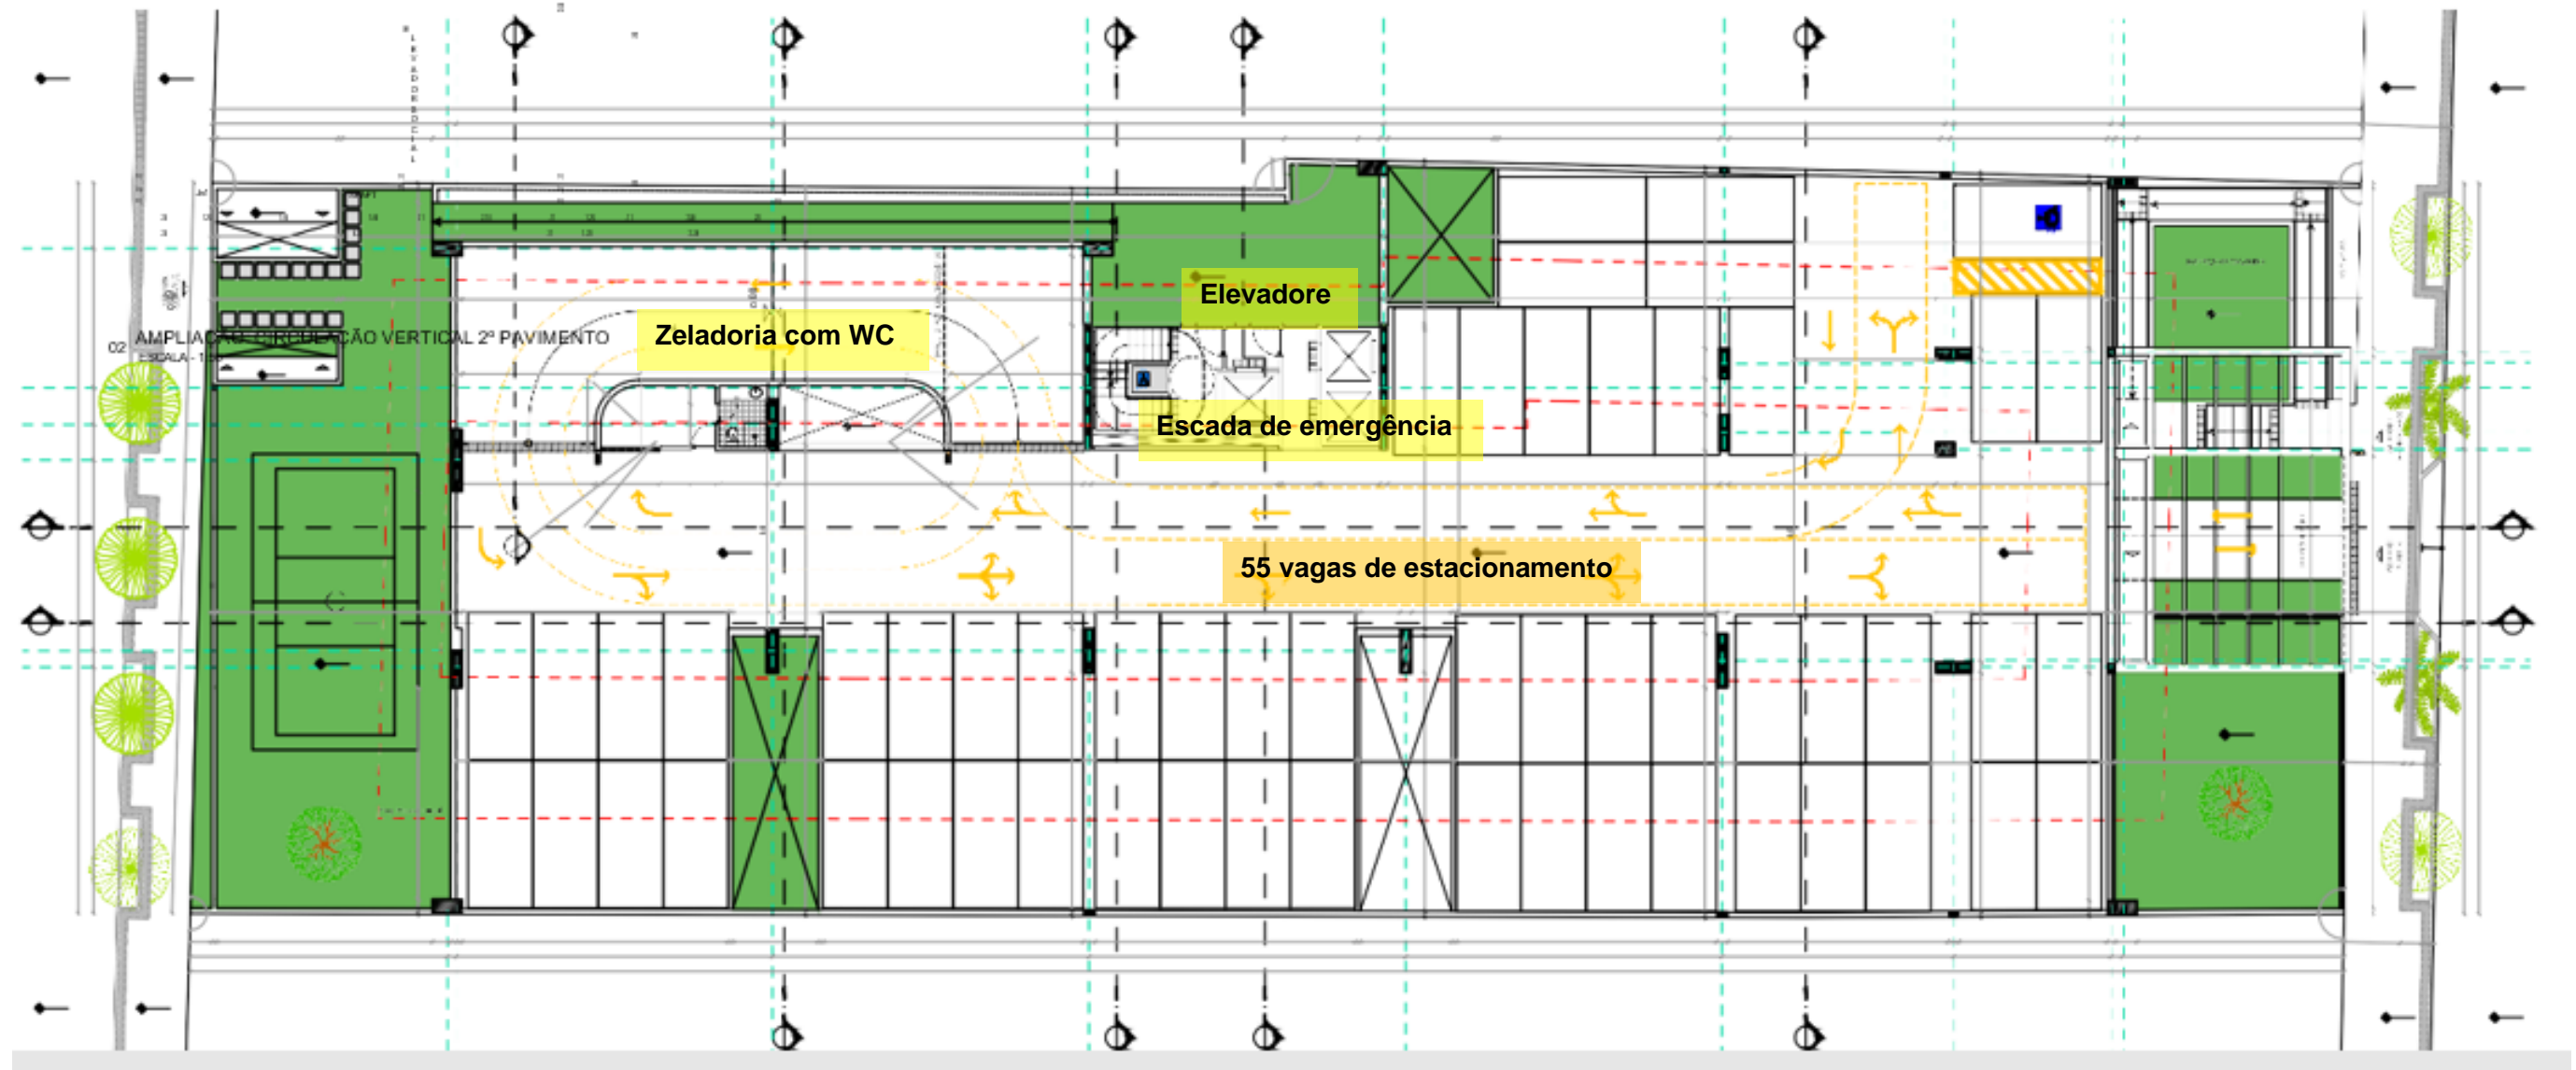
Planta Baixa 2º Pavimento – G3 – P04.13.
